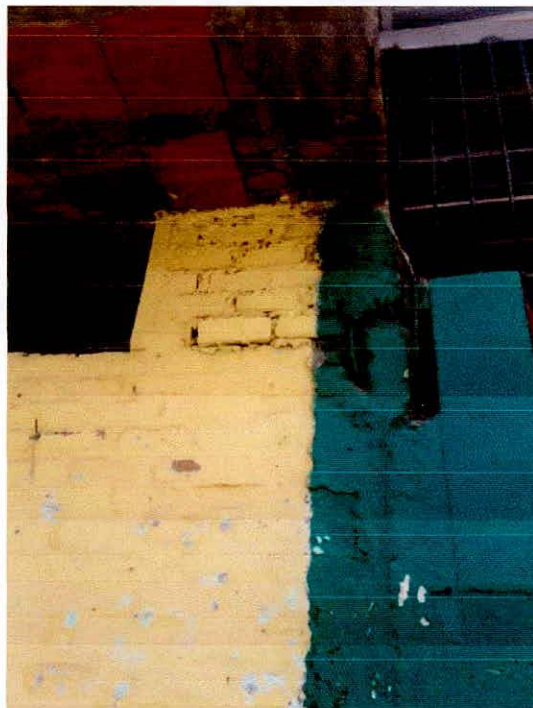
Vista de los daños ocasionados a la estructura de la columna donde los fierros se han doblado y no se han seguido con la sección de la columna.
